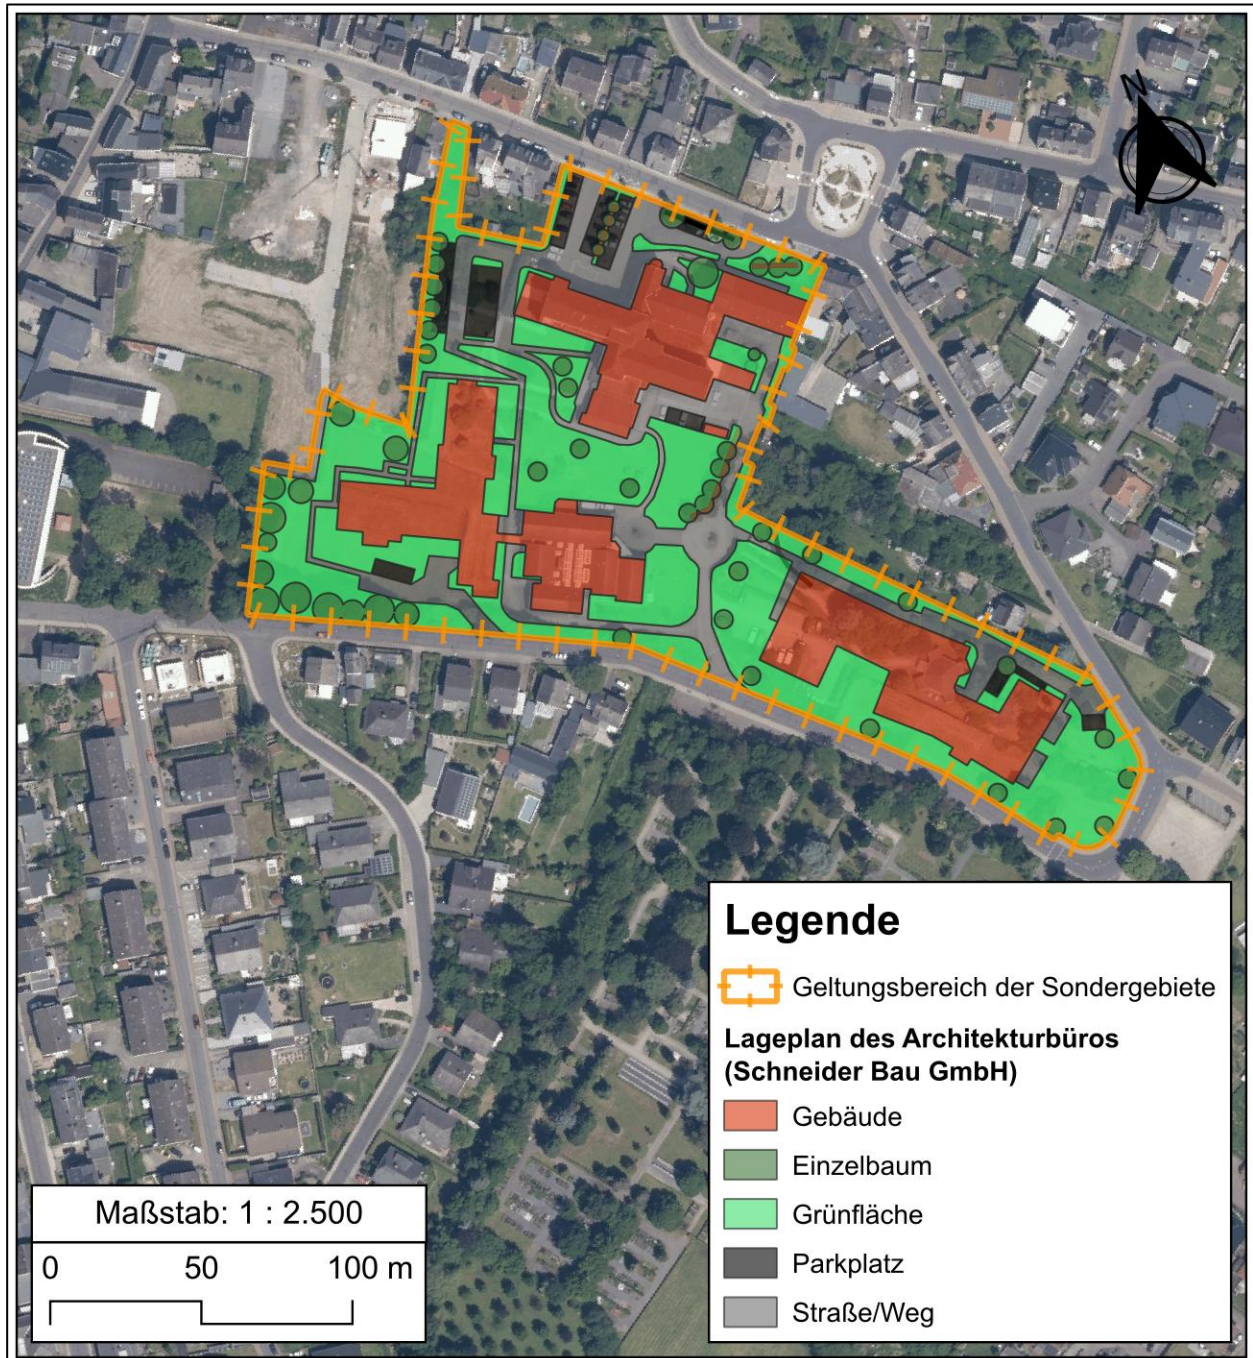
Lageplanung des Architekturbüros Schneider Bau GmbH
